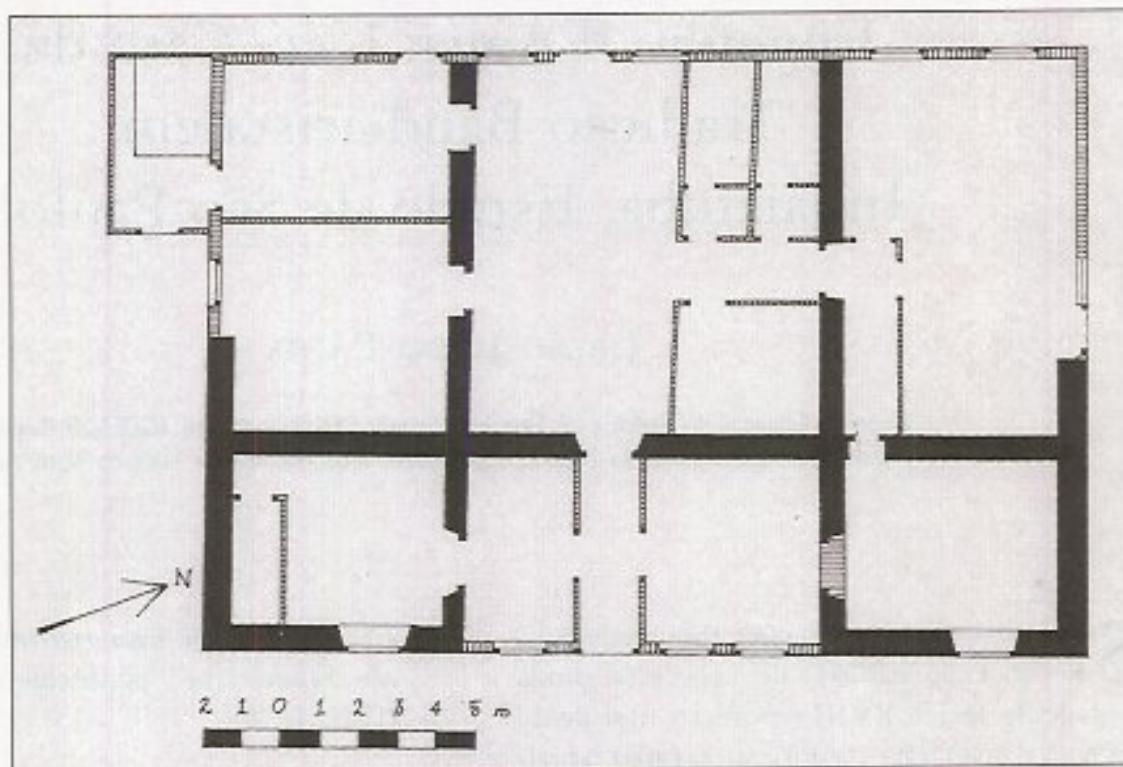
Planta-baixa da sede da antiga Fazenda Engenho d'Água, out. 1995/mar. 1996. As paredes em preto são de taipa de pilão e as demais de tijolos. Note-se a ligeira assimetria da planta e, na faixa fronteira, a área do pretório primitivo obturado com parede de tijolos. Desenhado pelo autor, set. 1995/dez. 1997.
